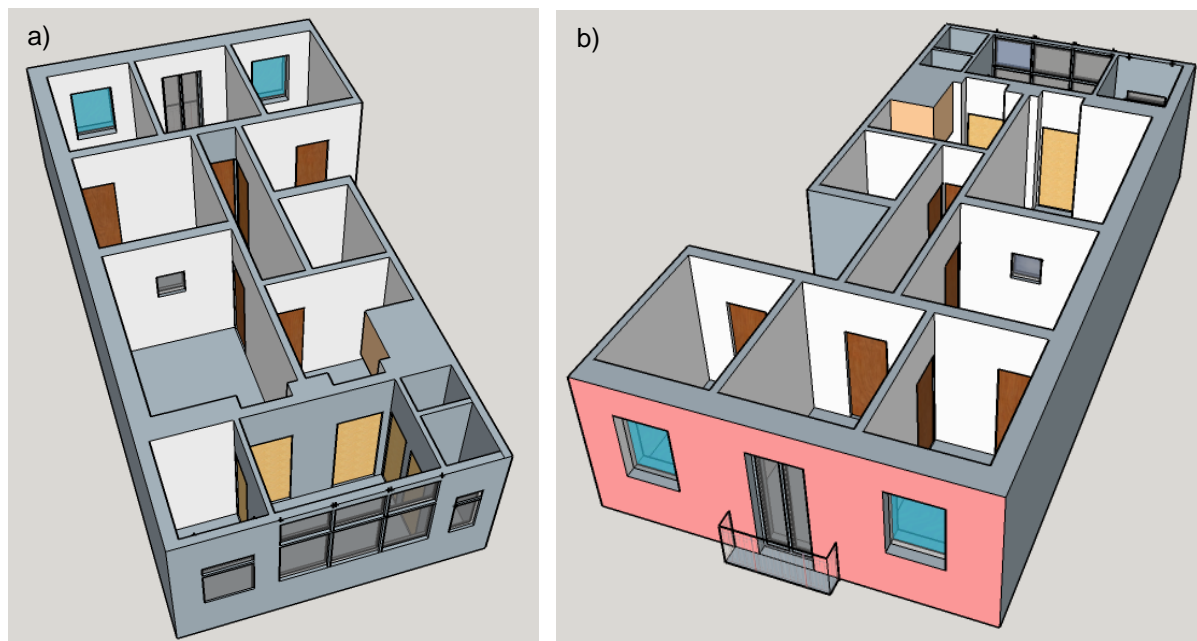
Duas vistas diferentes da planta a 3D de uma fração de tipologia T3+1. a) Vista da Fachada Principal; b) Vista da Fachada de Tardoz.
